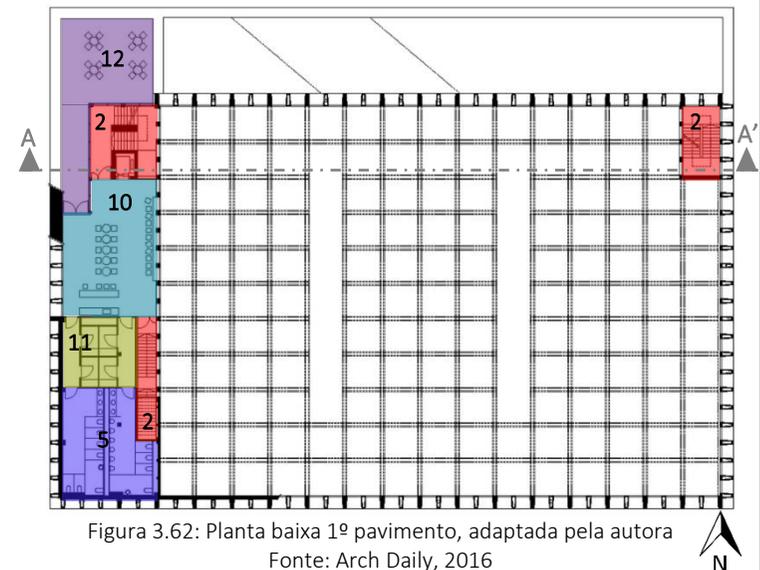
Planta baixa 1º pavimento, adaptada pela autora
